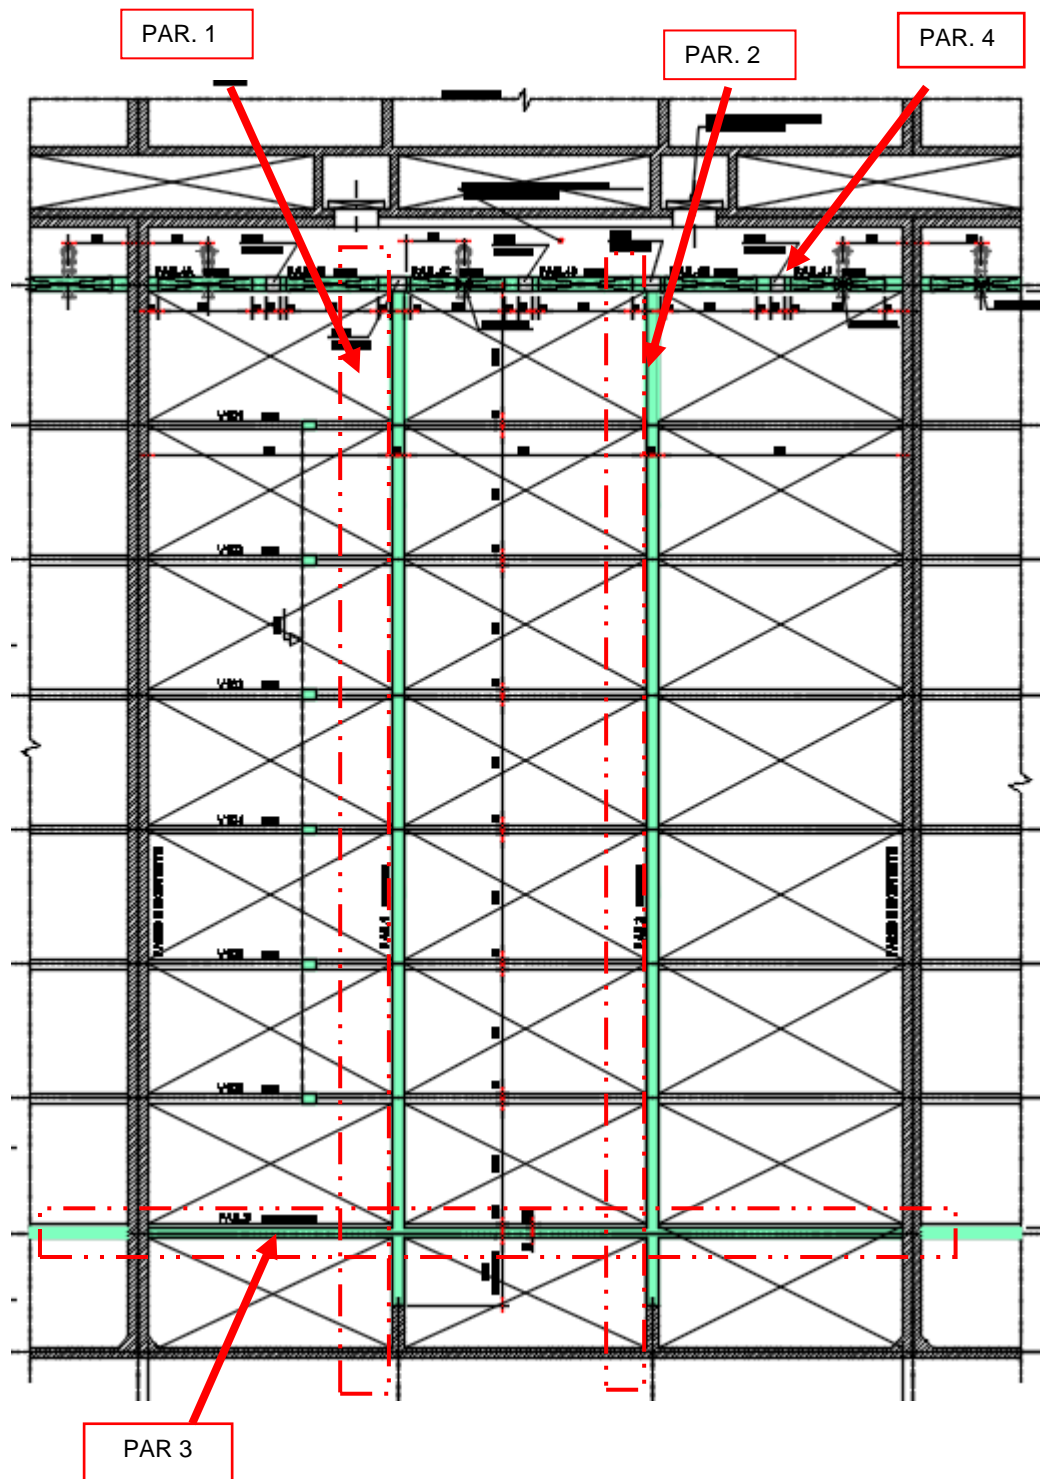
Lajes a serem executadas e impermeabilizadas
